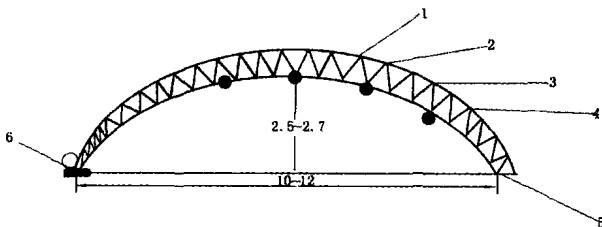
钢筋桁架无柱大棚的桁架结构(单位:m)
